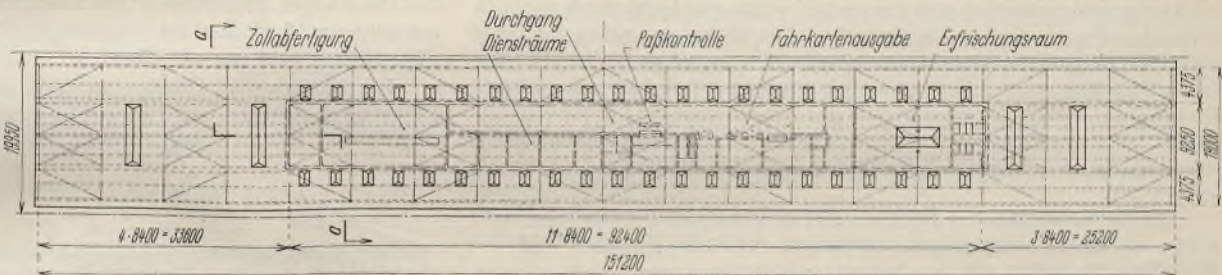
Grundriß der Zollhalle und Bahnsteigüberdachung.
